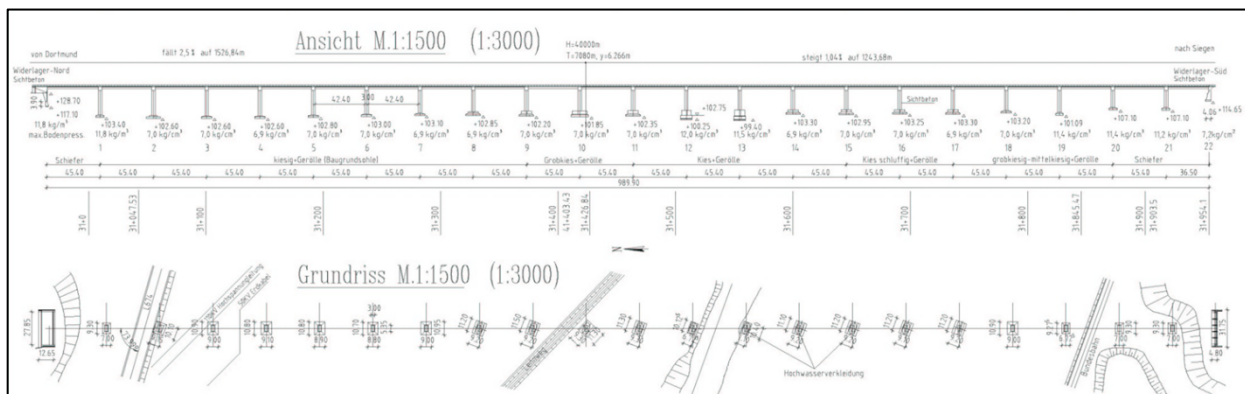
Übersicht der Bestandsbrücke (© Schüßler-Plan)
